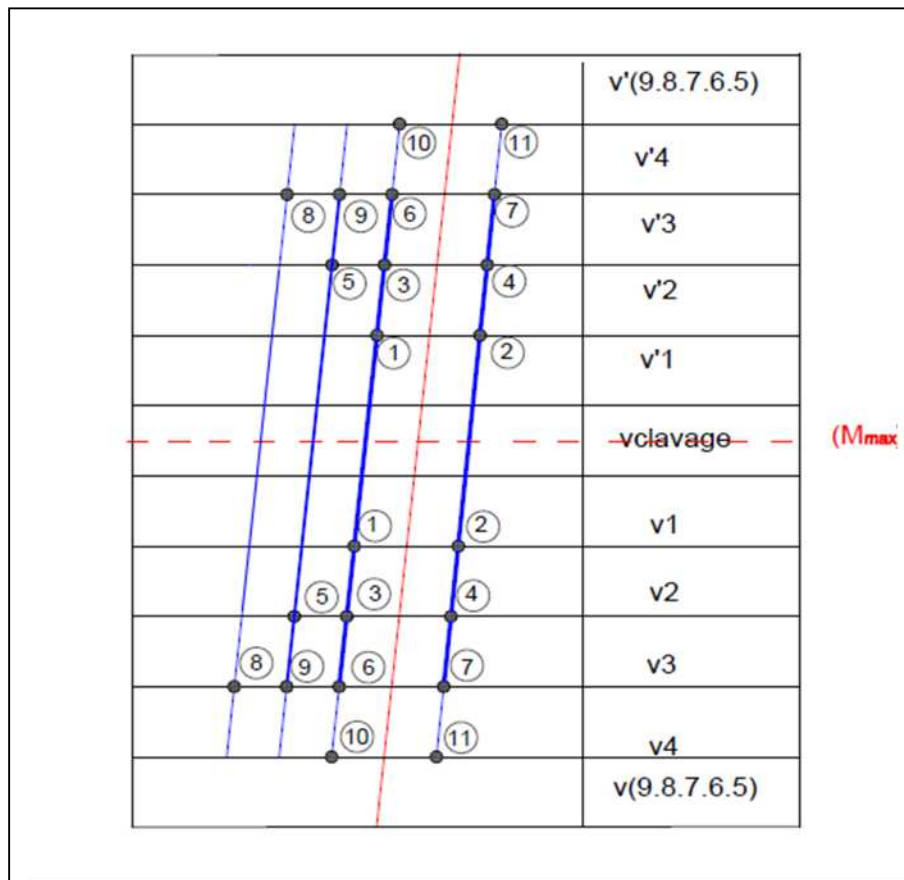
Disposition des câbles de continuité en plan (travée centrale).
